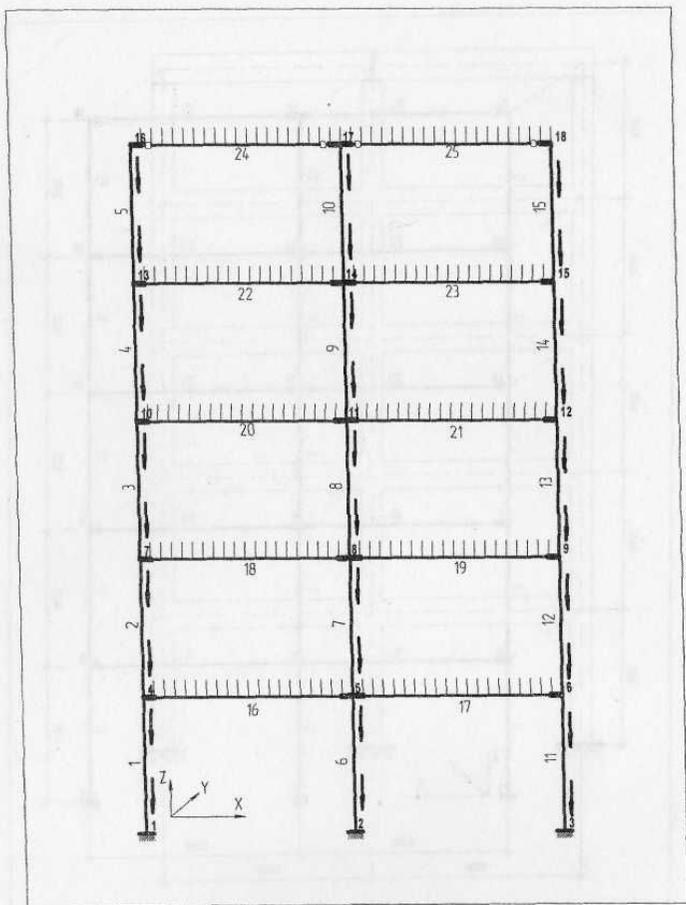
Постоянные расчетные нагрузки на раму (1-я схема)
